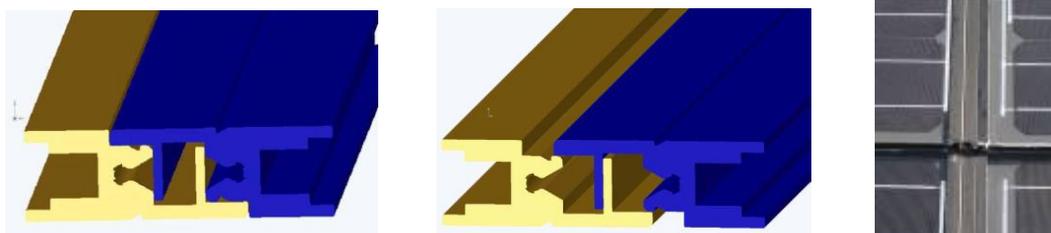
Principe d'emboîtement latéral → Recouvrement avec rattrapage de jeu et de faux équerage au niveau de la toiture
